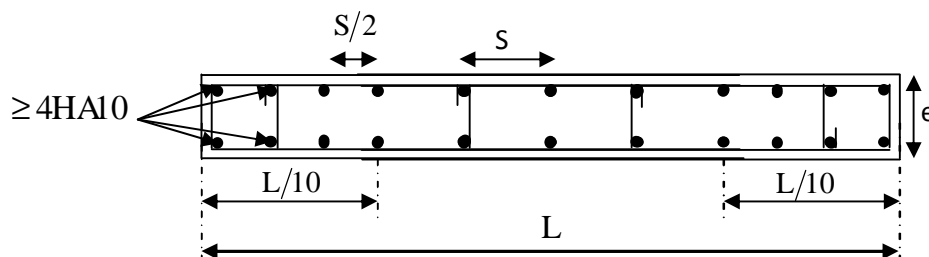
Disposition des armatures verticales dans les voiles
